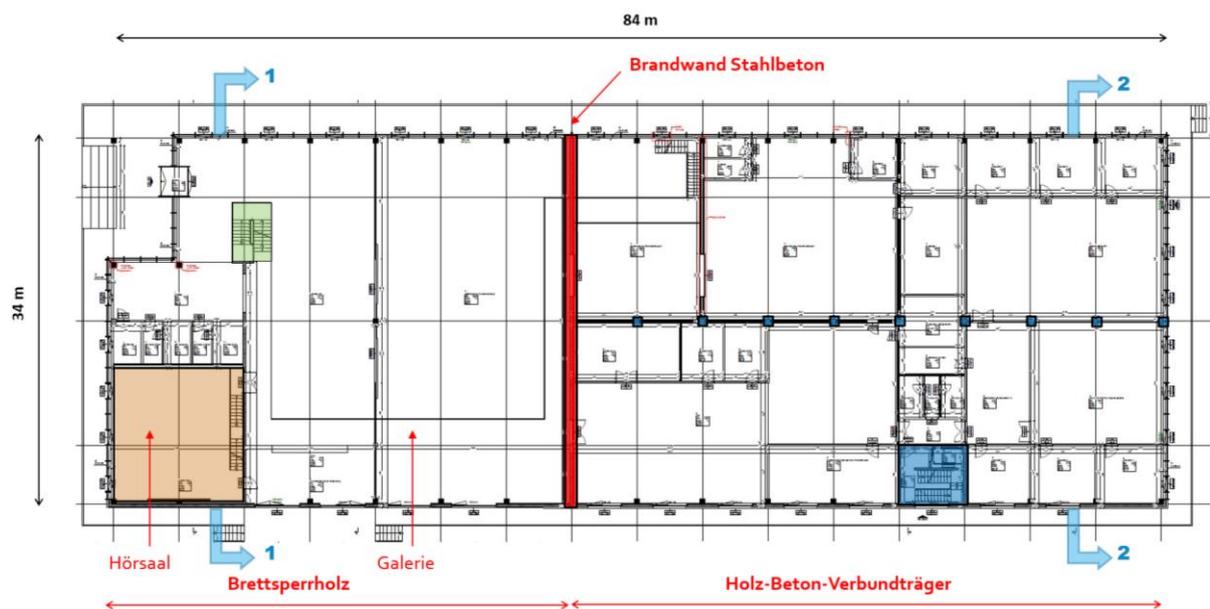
Grundriss Jowat [IfuH Architekten]
